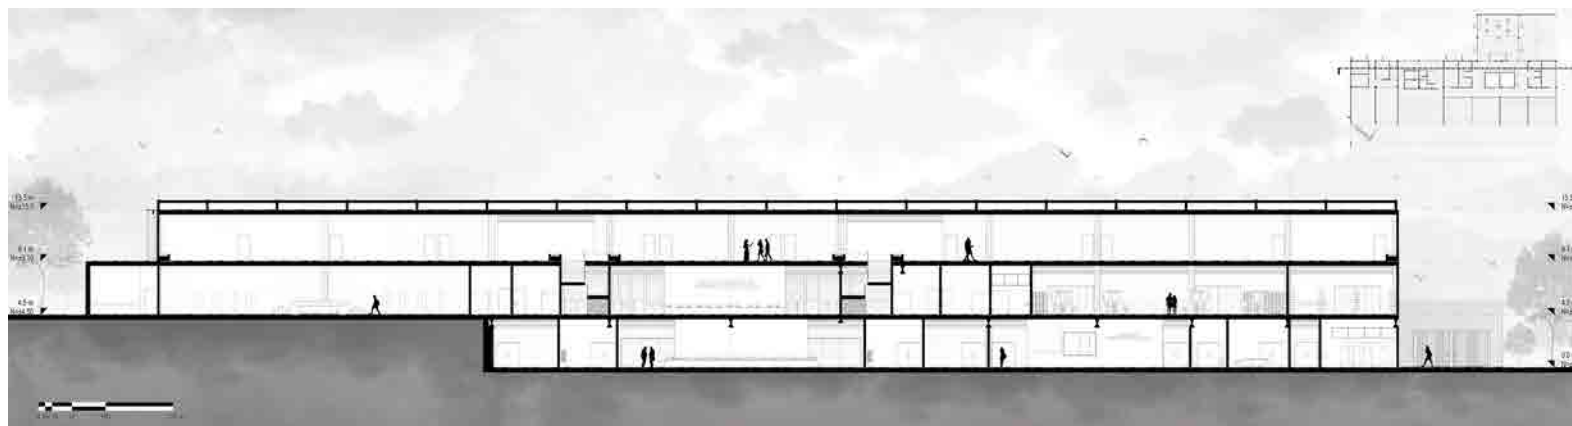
Sección longitudinal bloque izquierdo. Elaboración: Autores.
